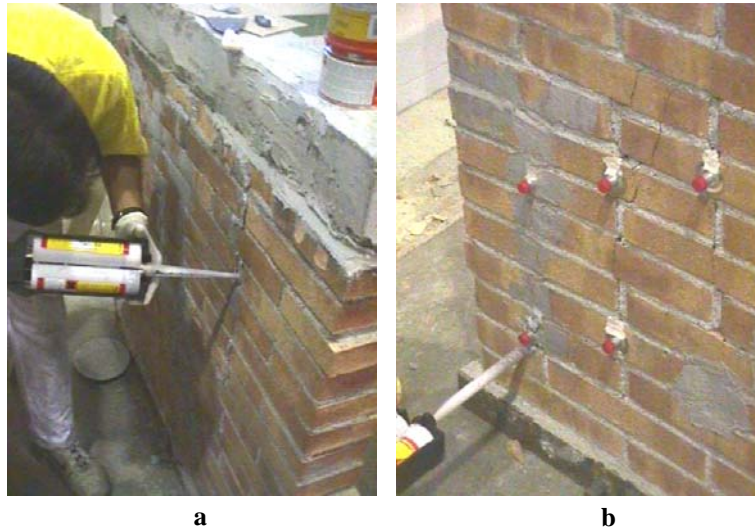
Reparación del panel 6: (a) Proceso de sellado de juntas con mortero epoxi, utilizando un aplicador de auto-mezclado; (b) fijación de bridas.
